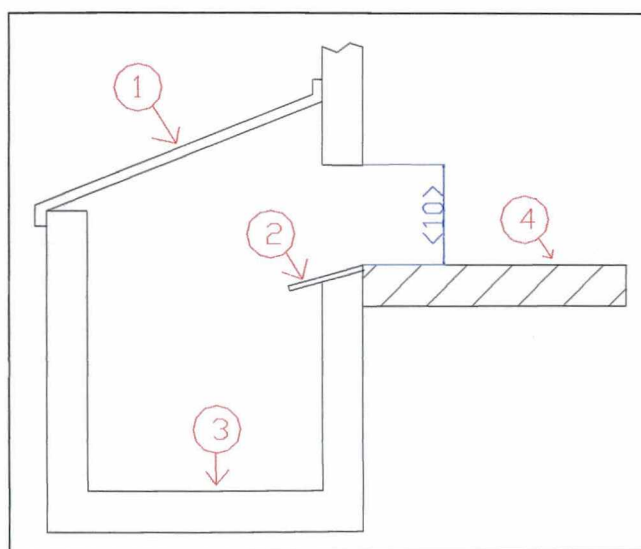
Canal e abertura de saída de dejetos das baias cobertos: 1 – cobertura do canal, em PVC rígido; 2 – chapa (PVC rígido) de saída de dejetos das baias; 3 – canal de captação de dejetos; 4 – piso da baia
